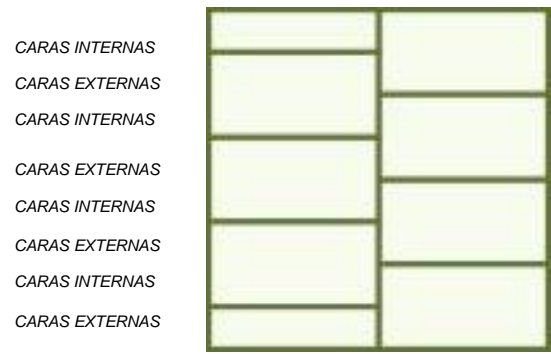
Configuración de las secciones en las vigas para las cepas.
